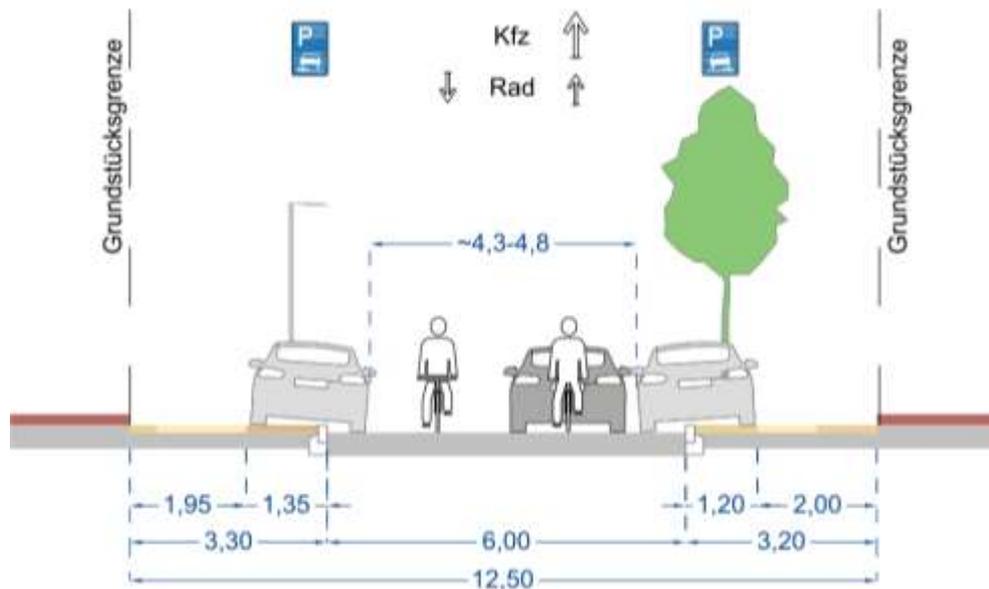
Straßenquerschnitt Cäsarstraße - Variante 6
